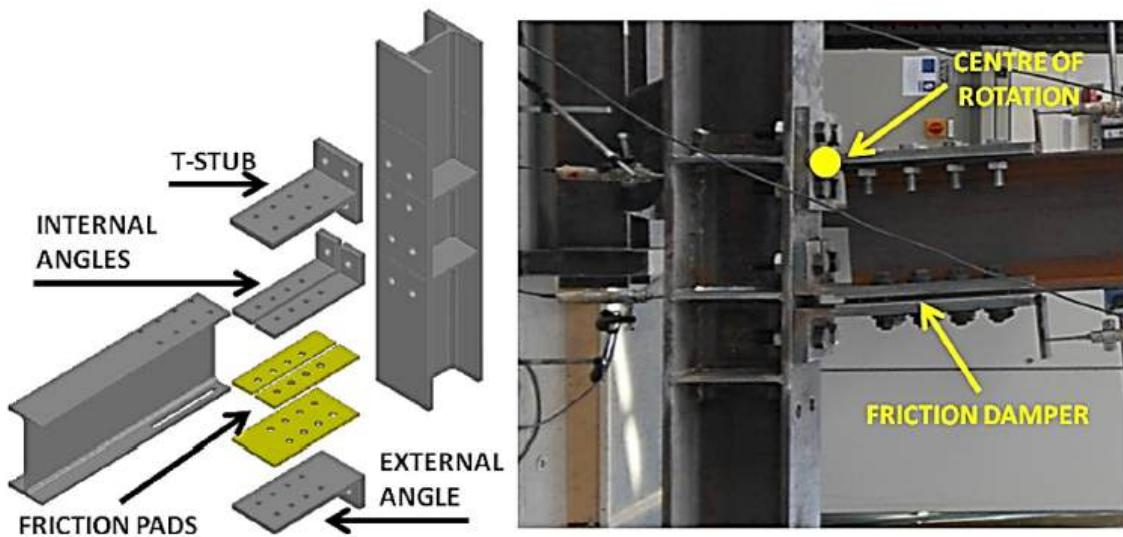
Connexion poutre-colonne équipée d'amortisseurs à friction [63]
